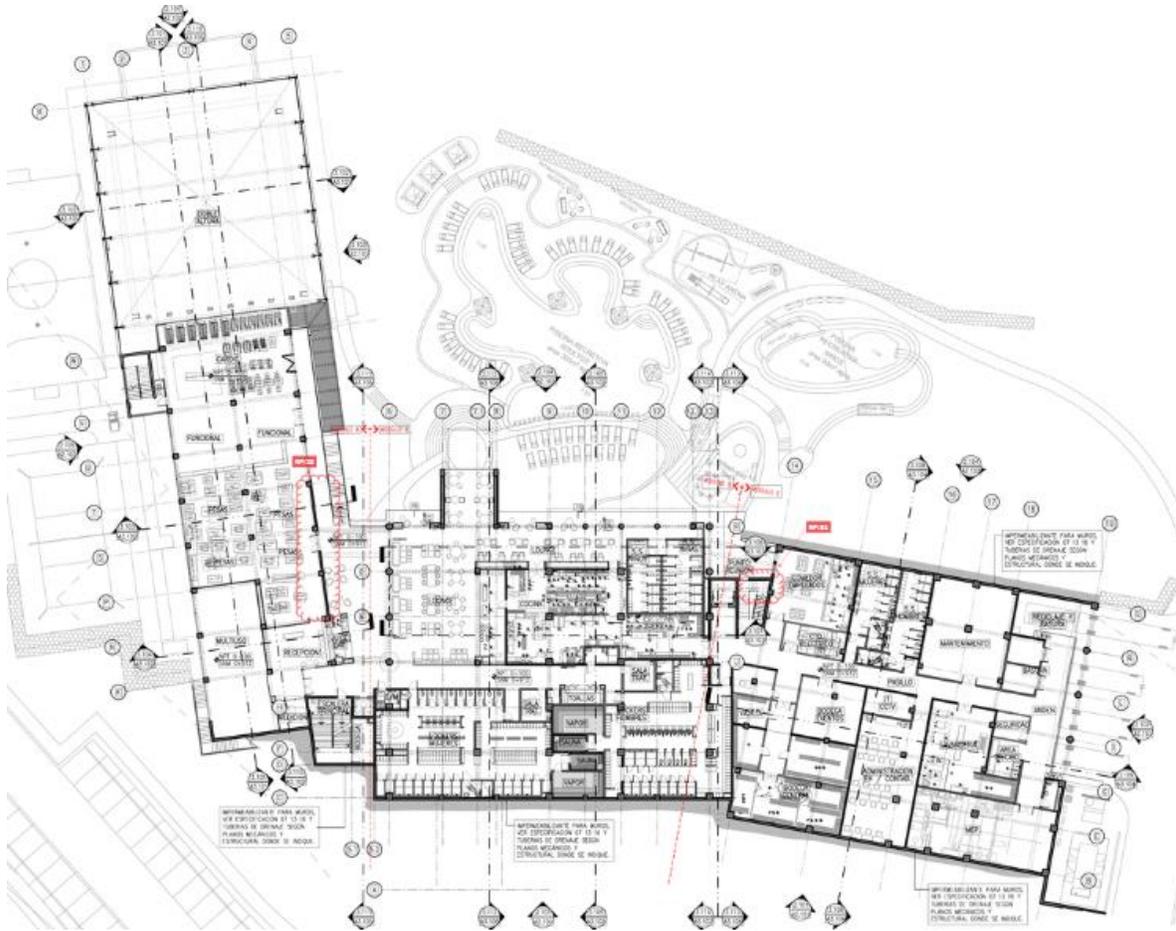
Planta arquitectónica de los tres módulos, nivel 912 (-100). Fuente: EDIFICAR, 2018.
